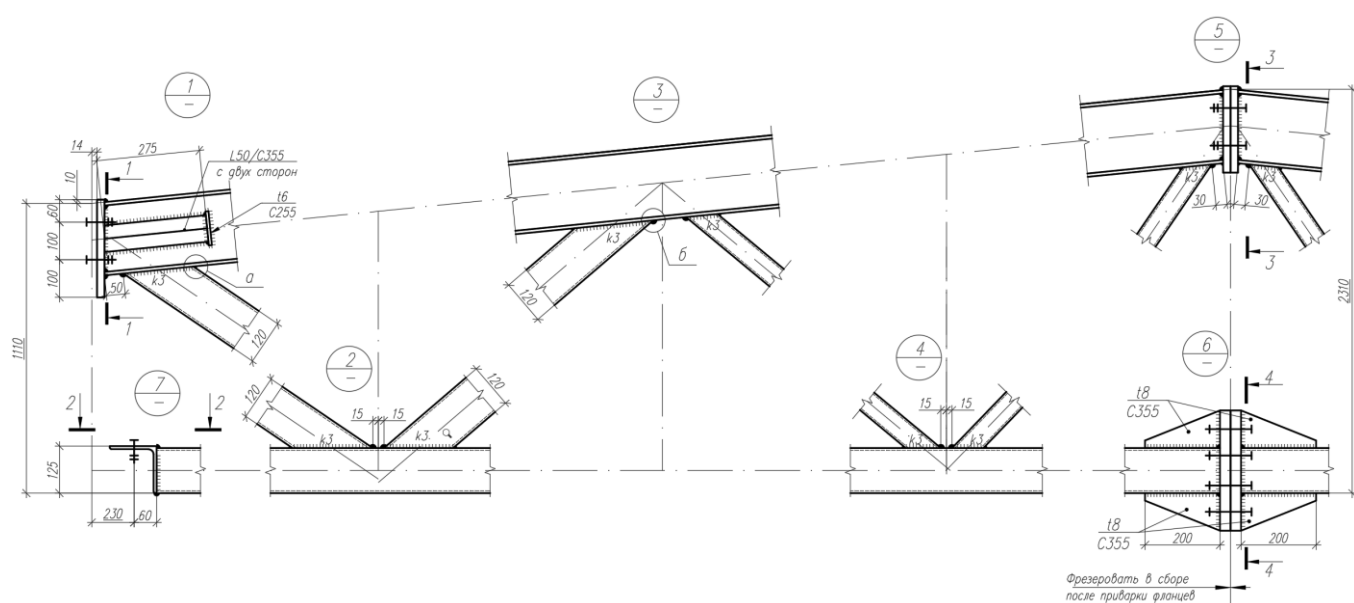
Узлы фермы ФС-24/10-1,95.
